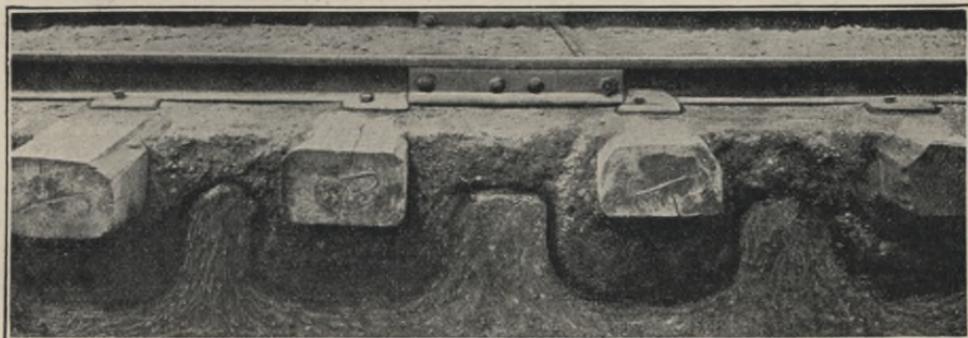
Verhalten der Bettung bei nachgiebigem Untergrund.
